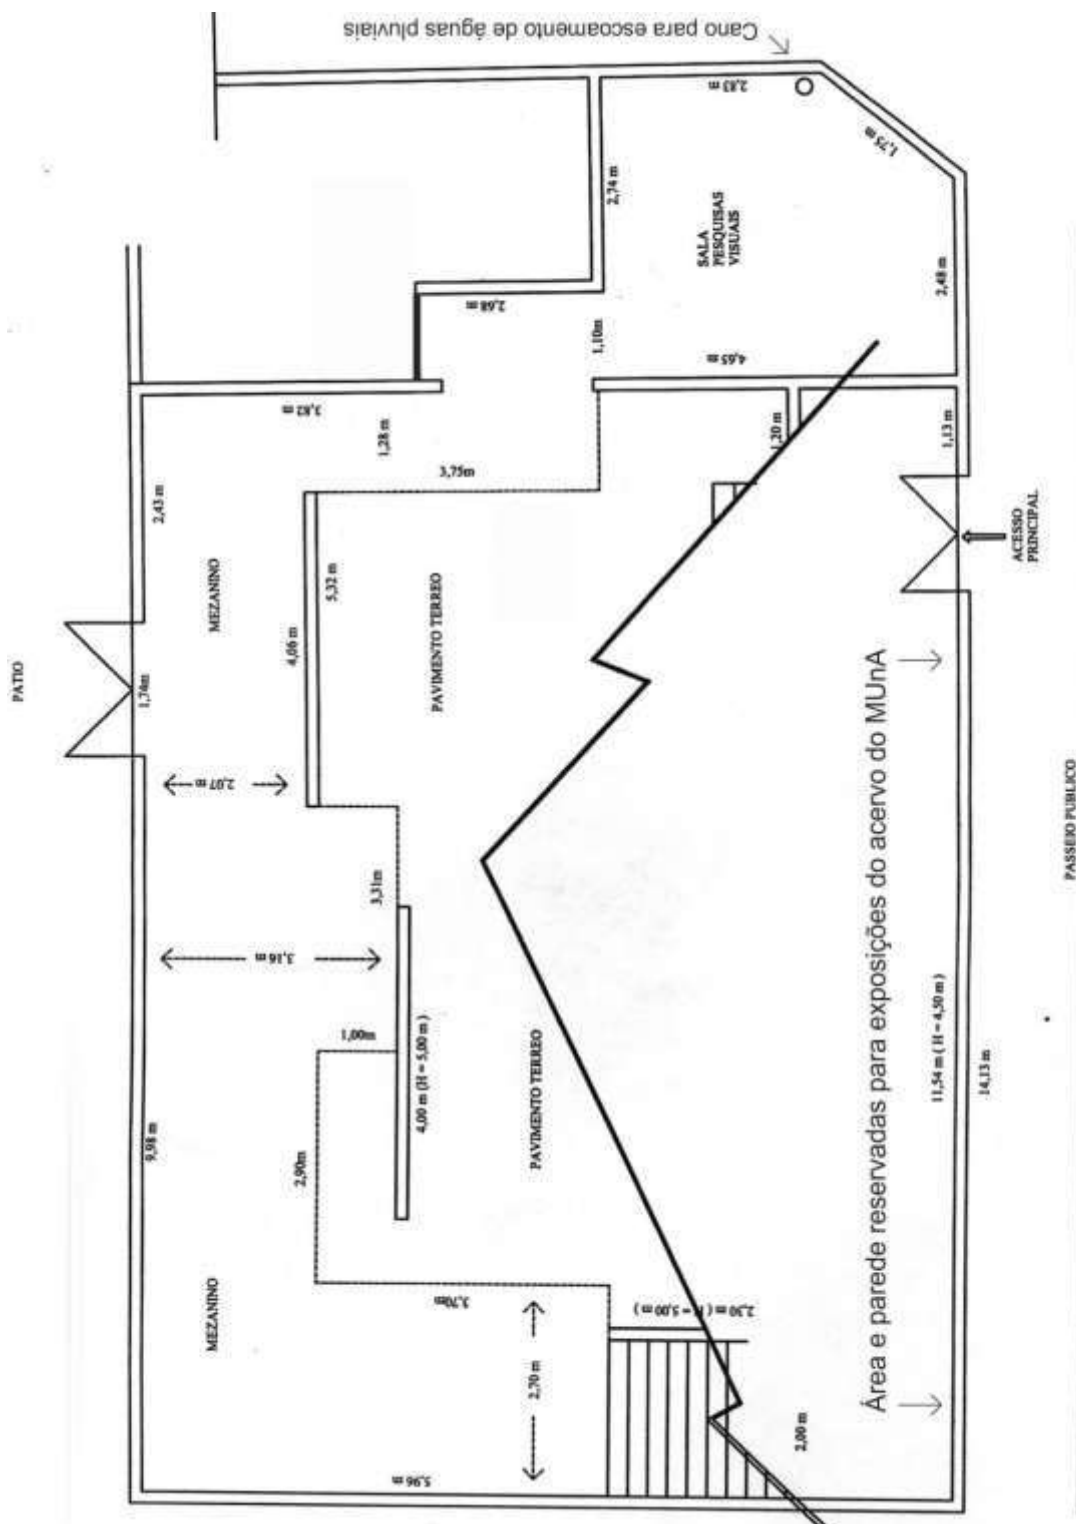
Planta térreo - galeria (desenho: Prof. Gustavo Echenique Tarditti)
